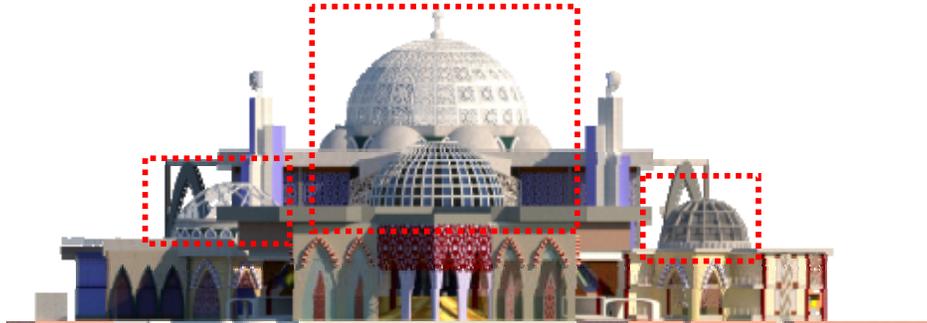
Penerapan material alami kayu yang member kesan klasik
